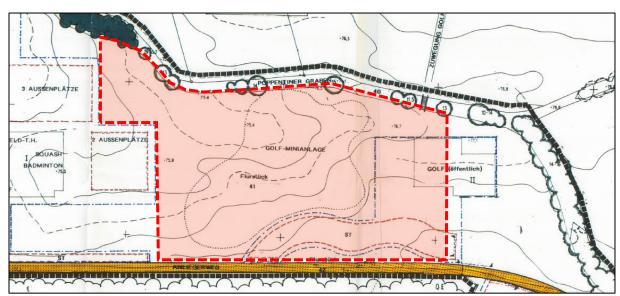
überplante Fläche des Ursprungsplans mit der Fläche des vorh. Bebauungsplan Nr. 19 "Campingplatz am Tannenweg"
